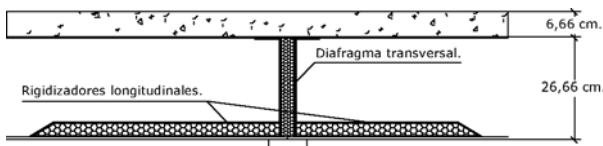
Sección longitudinal de la estructura en zona de apoyo.
